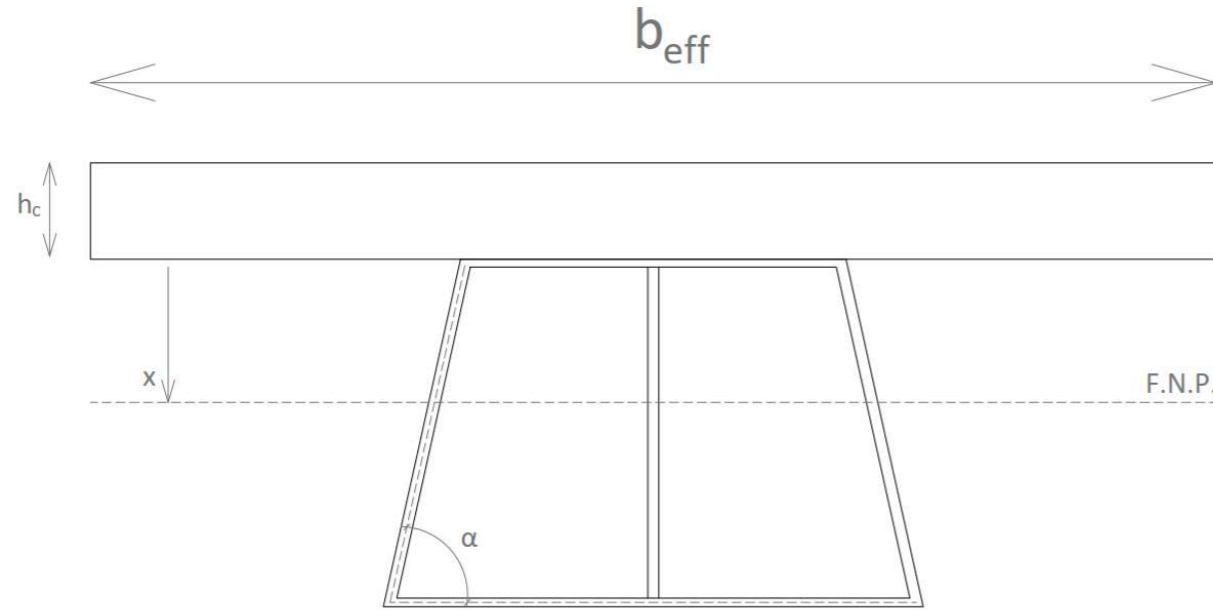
Fibra neutra plástica en el alma de la viga longitudinal (fuente: elaboración propia)
